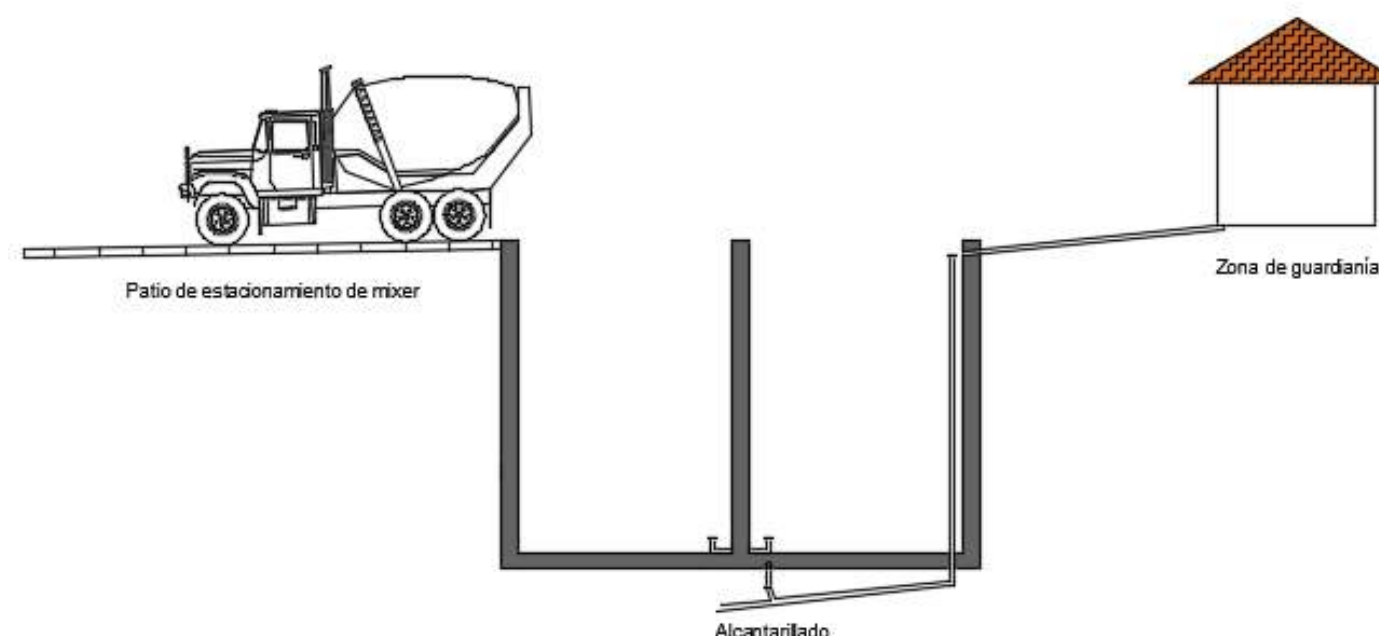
Esquema en perfil de la zona de lavado de Mixers.
